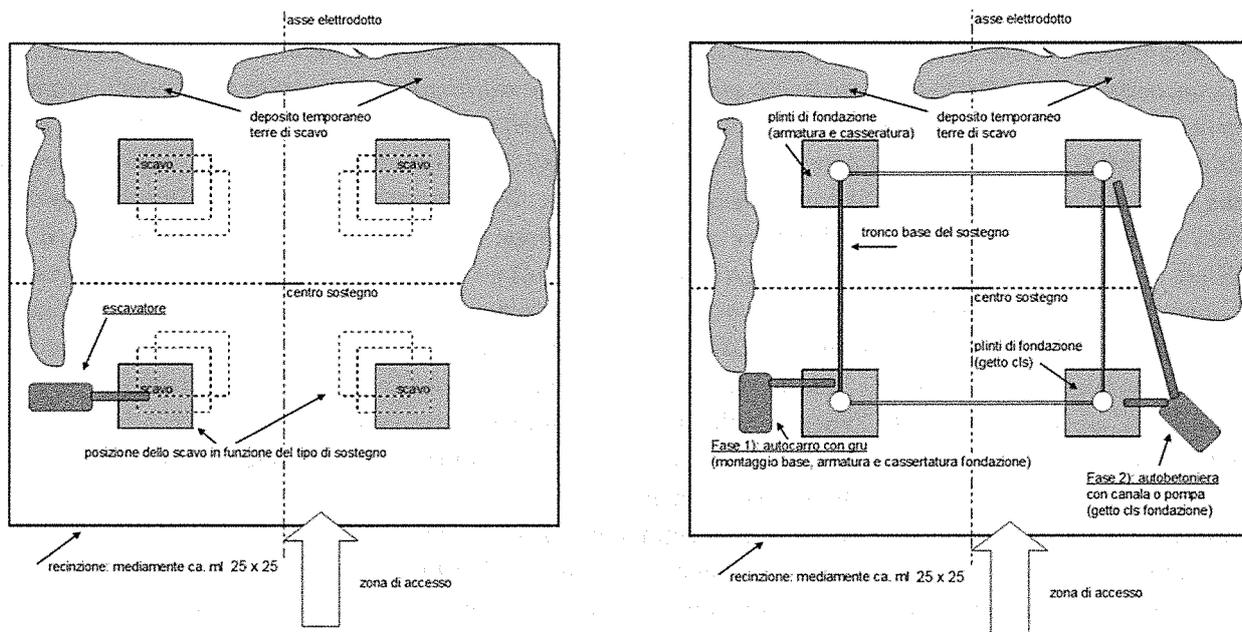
Planimetria dell'Area Sostegno (scavo di fondazione - getto e basi), tipologico
